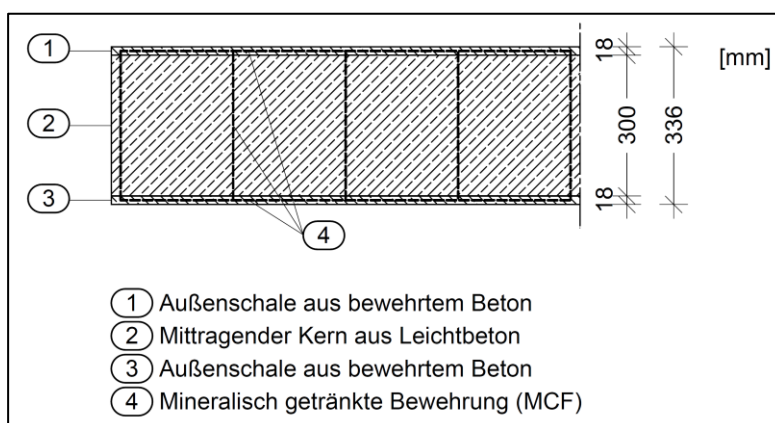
Modulares Sandwich-Deckenelement zur Bemessung und Auslegung der räumlichen Bewehrungsstruktur für den Demonstrator
